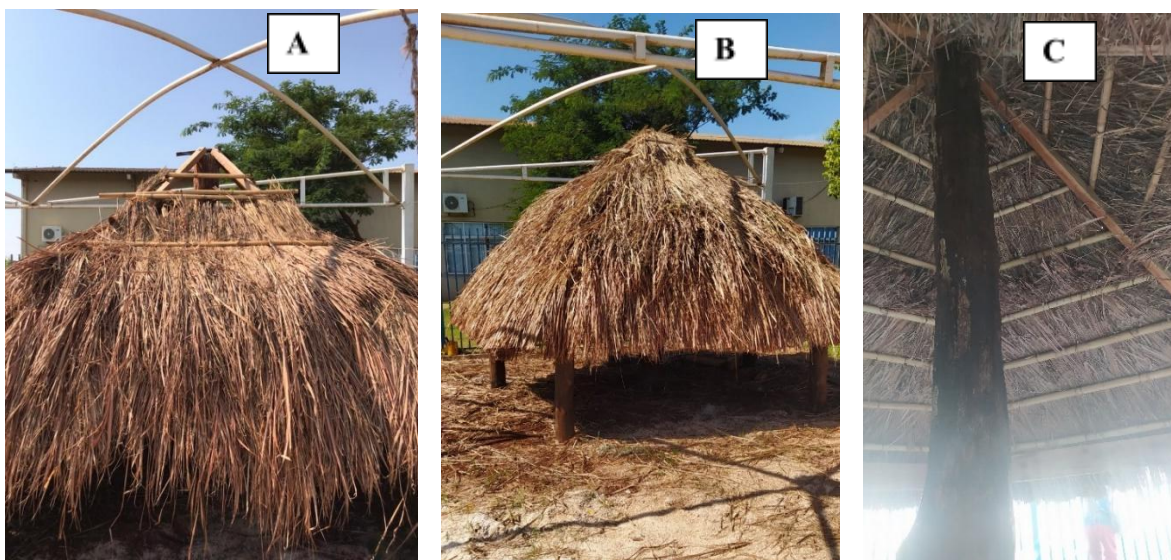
Detalhe da execução da estrutura de cobertura da oca.
